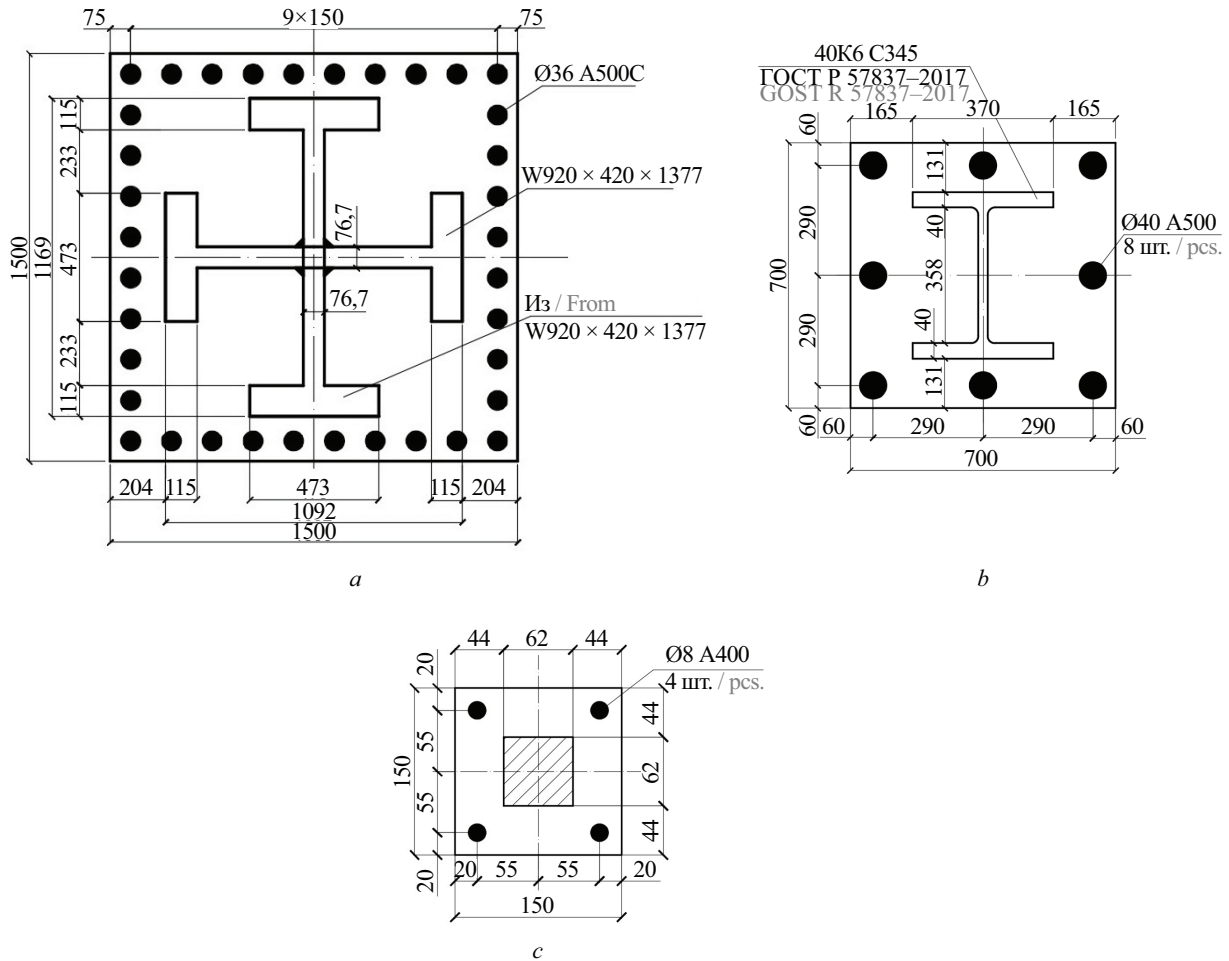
Поперечное сечение сталежелезобетонной колонны с жесткой арматурой в виде: *a* — двух накрест расположенных сварных двутавров [13]; *b* — прокатного двутавра⁷; *c* — сердечника сплошного сечения⁷
